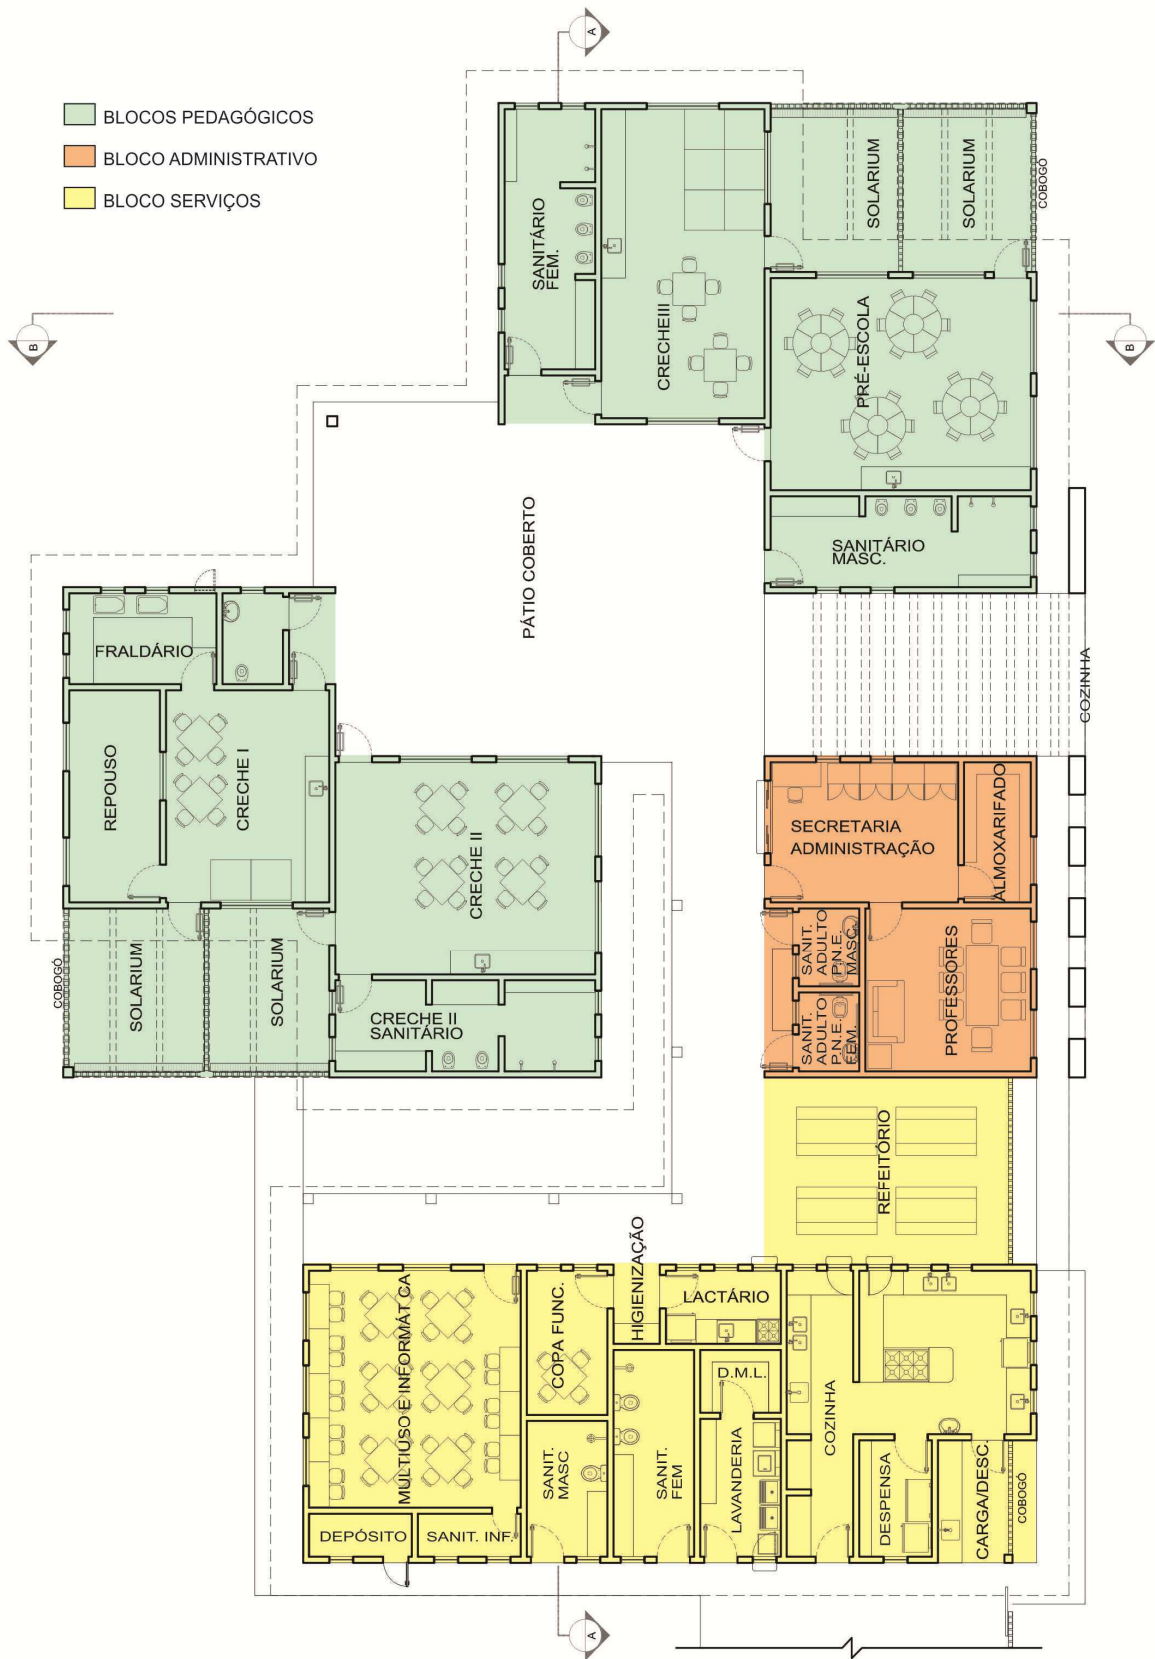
Planta Baixa do Projeto Padrão Tipo-C (sem escala)
